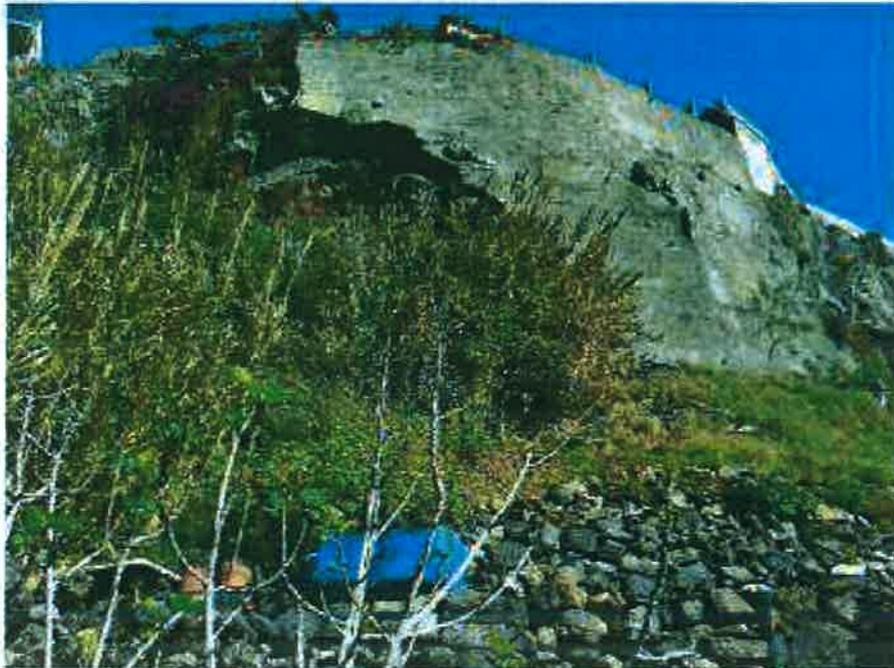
Desmoronamento da parte do muro de suporte na zona nascente da área de intervenção
